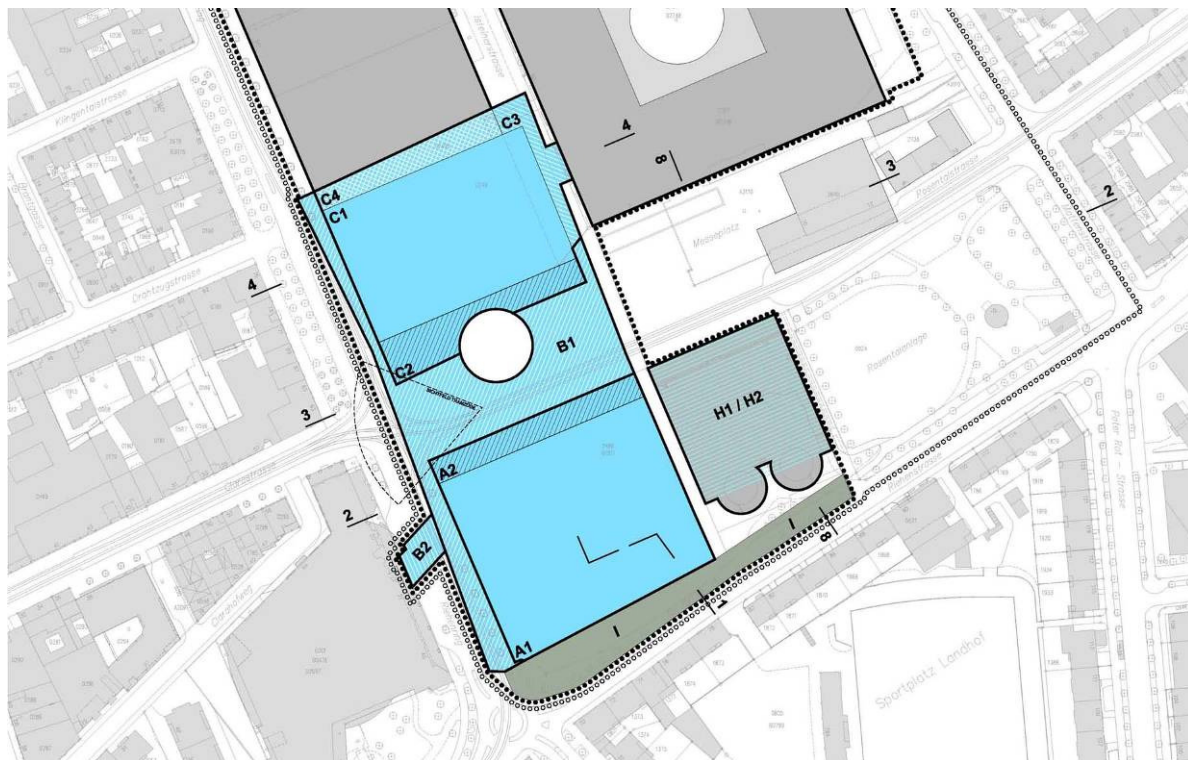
Bebauungsplan Plan-Nr. 13'241: Situation (kein Massstab, Plan genordet)
